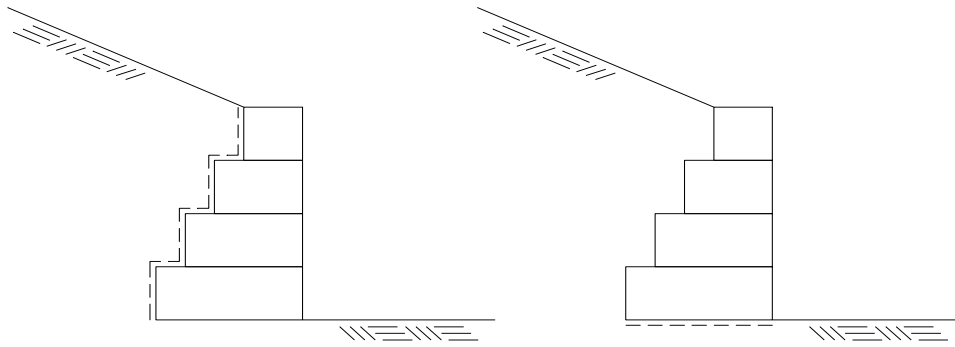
Detalhe do posicionamento do filtro geotextil ao tardoz ou na base da estrutura.
